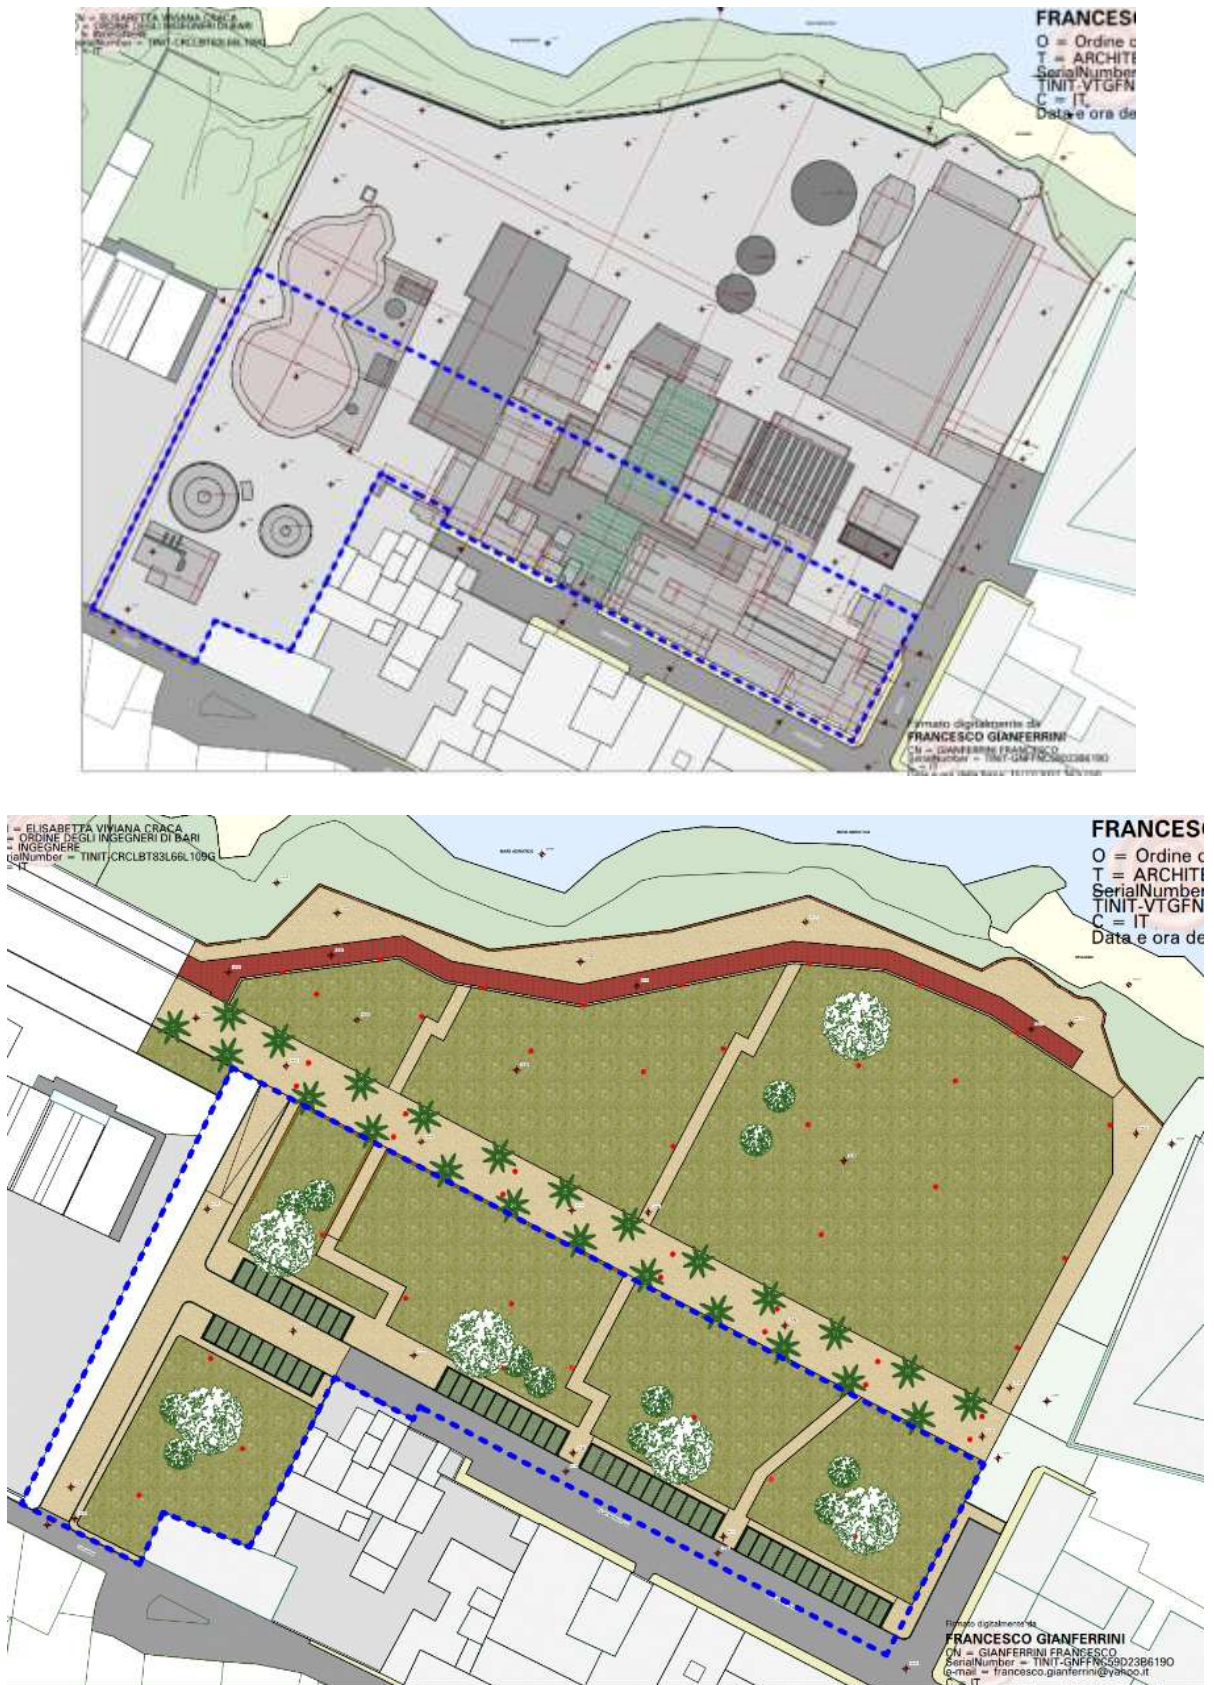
Planimetria stato attuale e di progetto zona “Villa Costa Nord”
